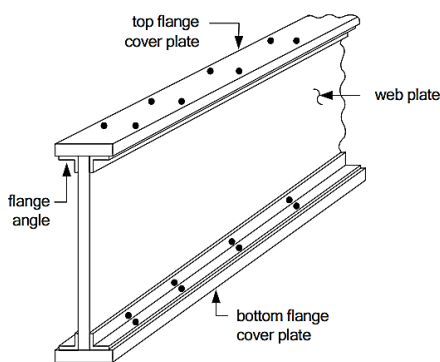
Viga Construida con Placas Remachadas - Internamente Redundante.[6]
